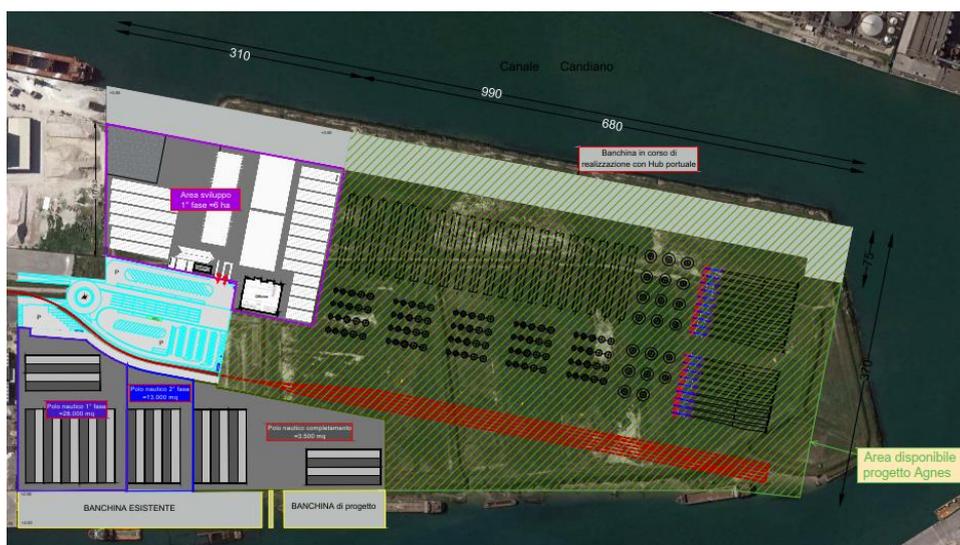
Ipotesi di stoccaggio: monopali e pale in posizione orizzontale, elementi di transizione e torri in posizione verticale
